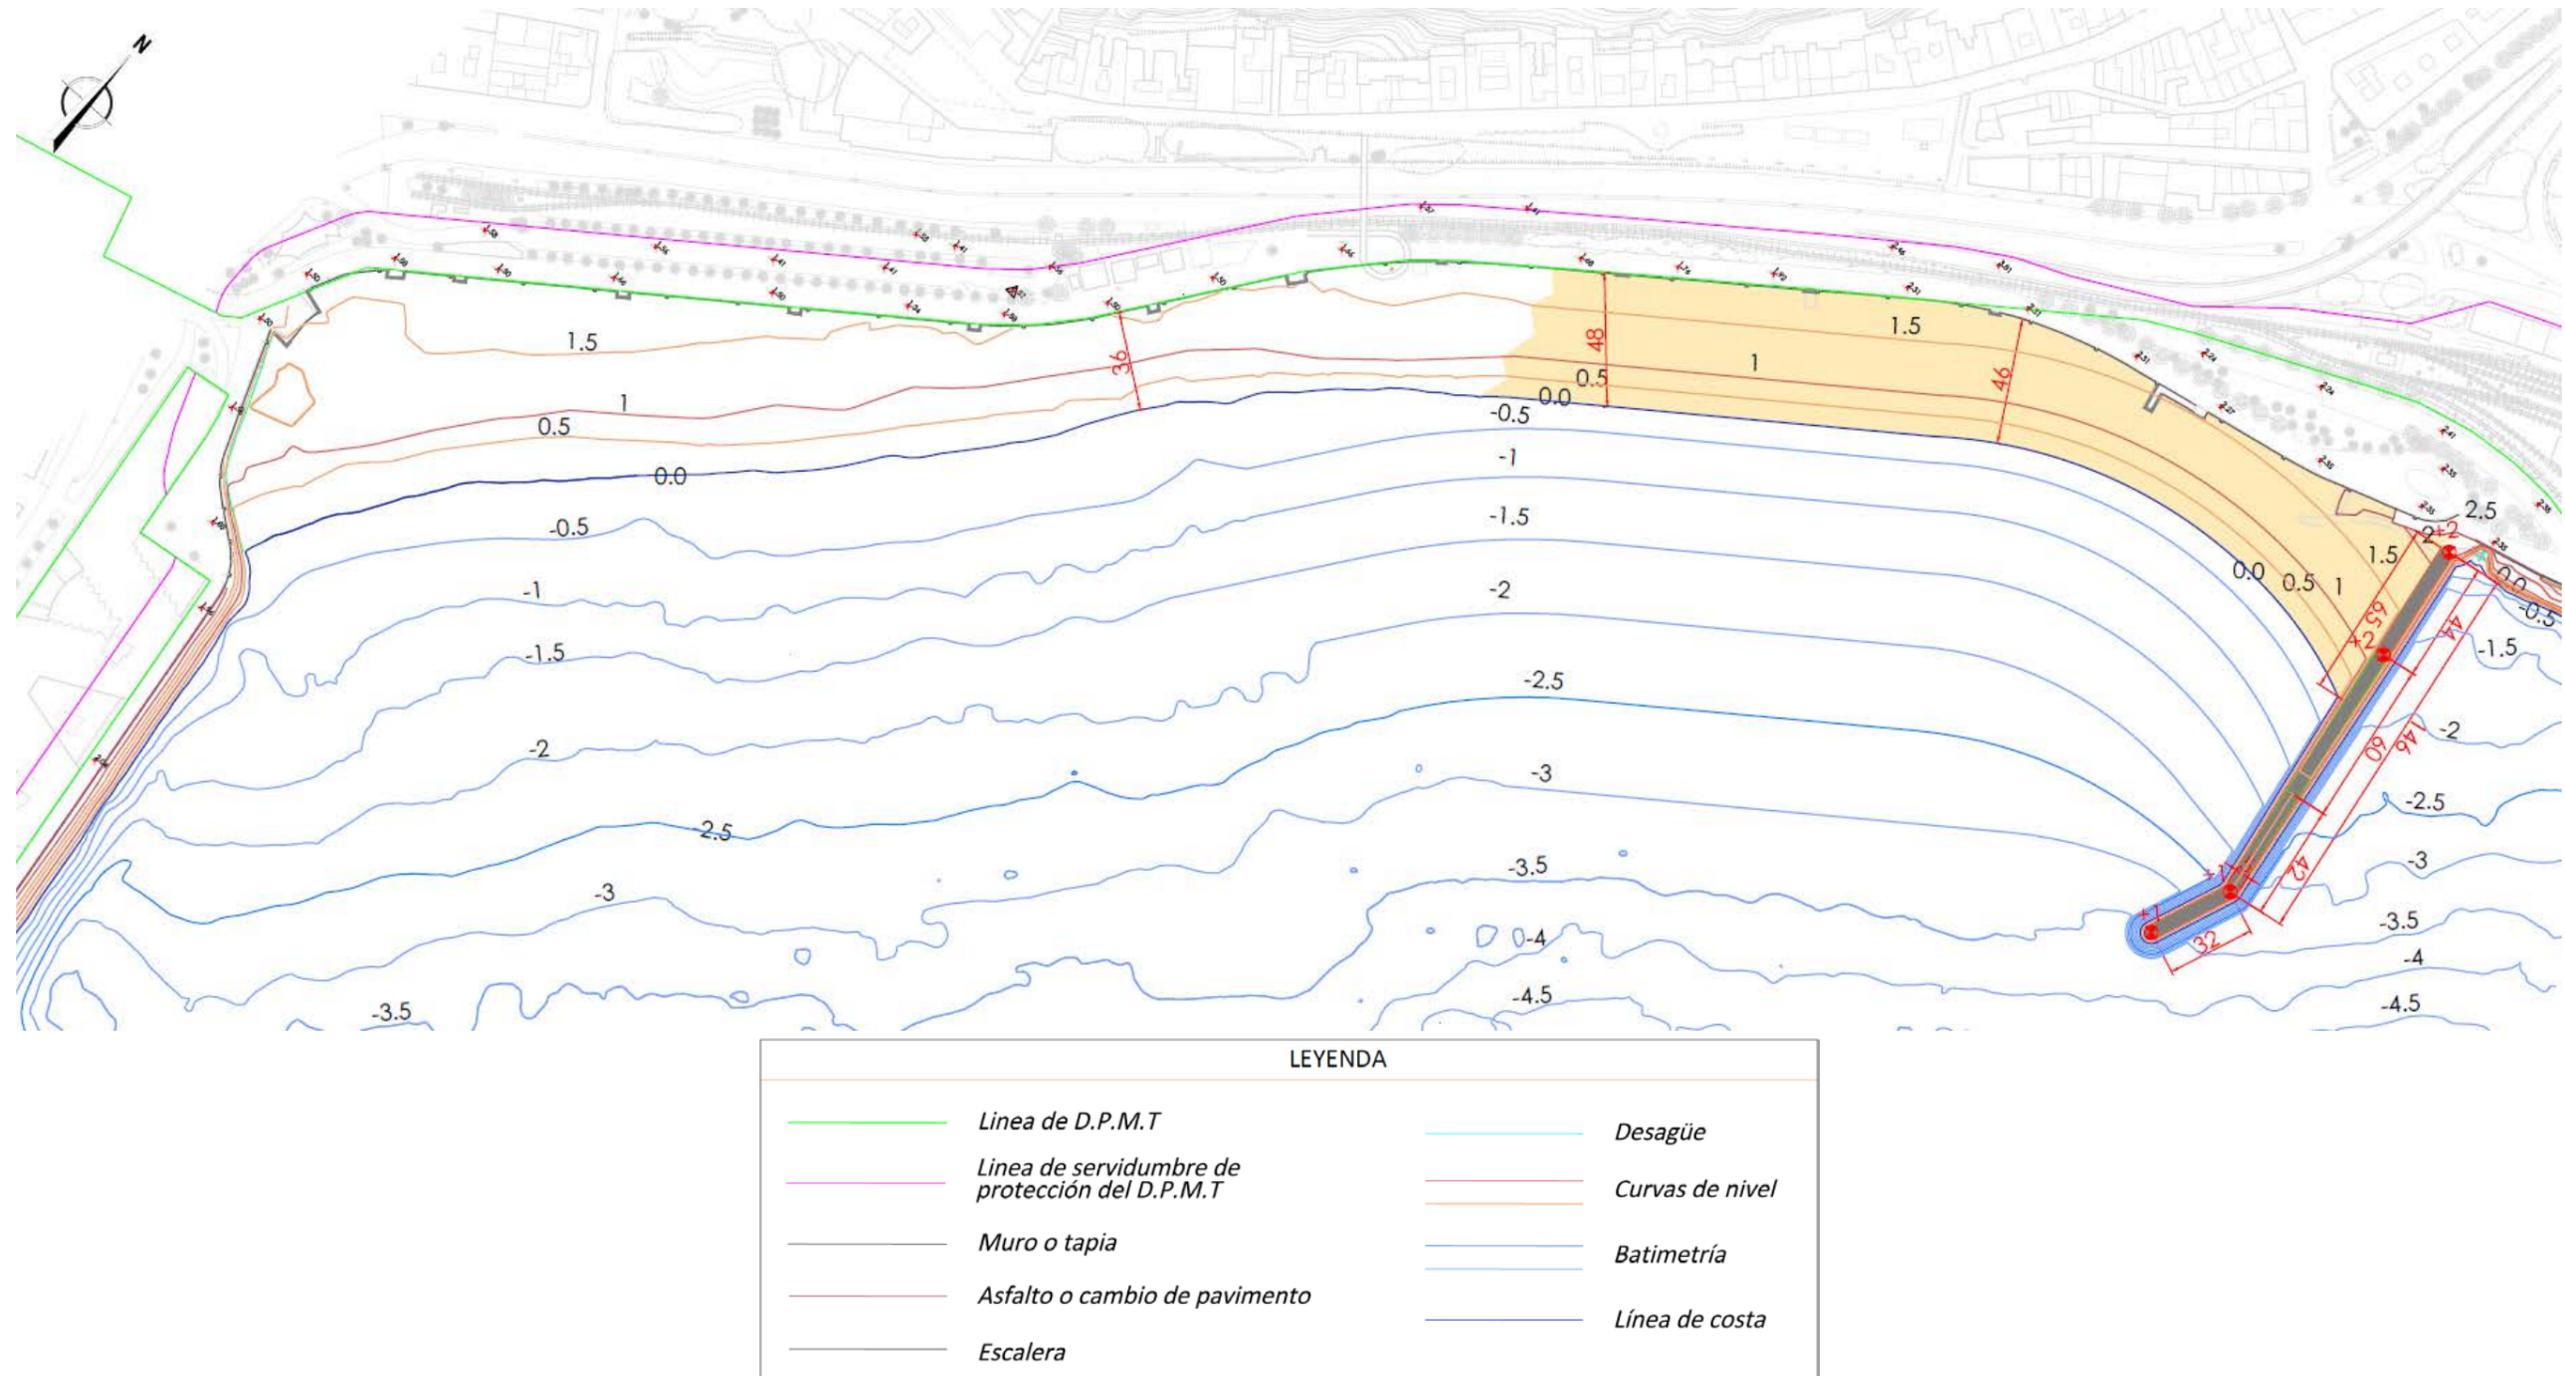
Plano de la actuación proyectada, estado futuro. Cotas en metros respecto del NMMA.
